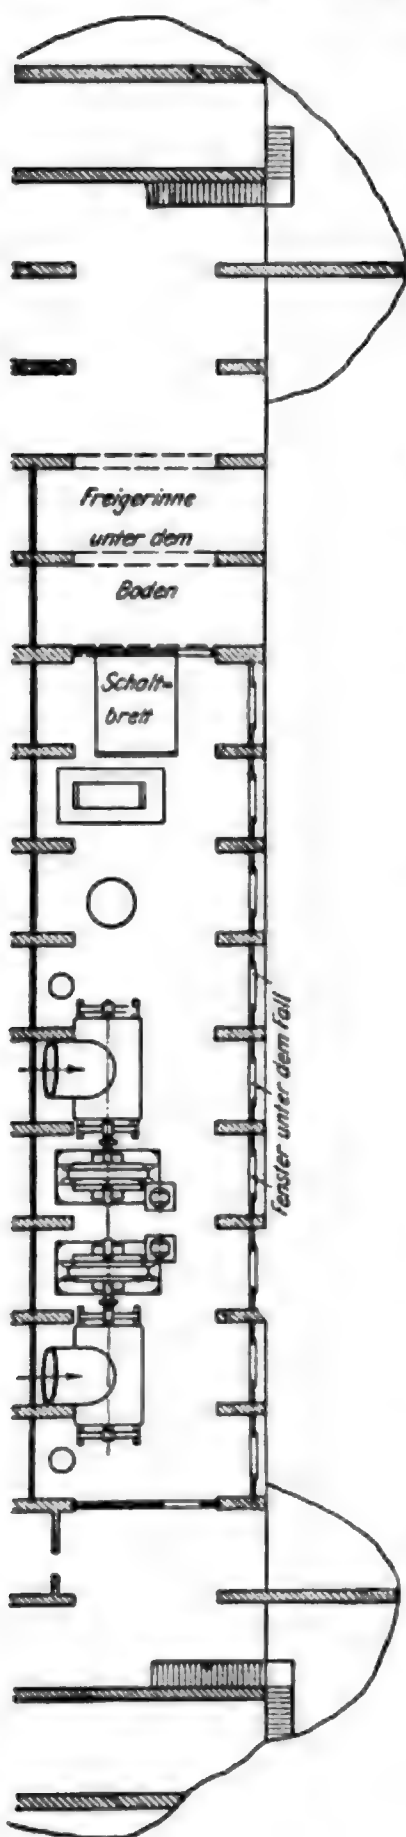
Grundriss der Sperrmauer im Siouleffusse mit Krafthaus.
